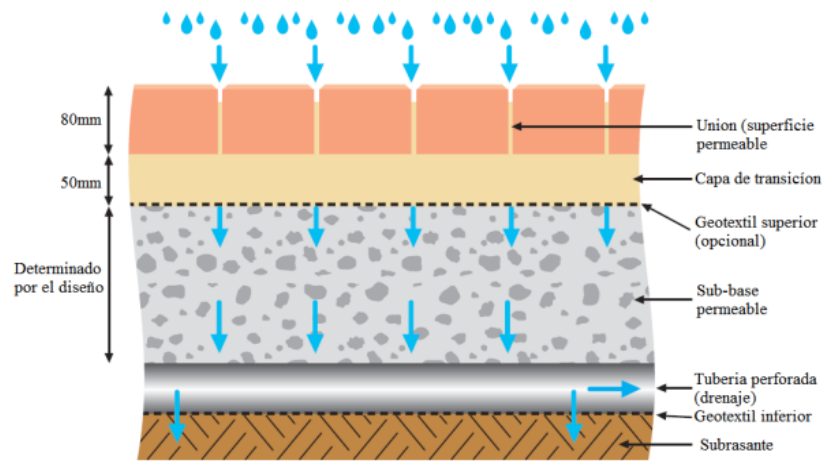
Estructura del pavimento permeable de infiltración parcial. (Adaptado de: Interpave, 2008).
